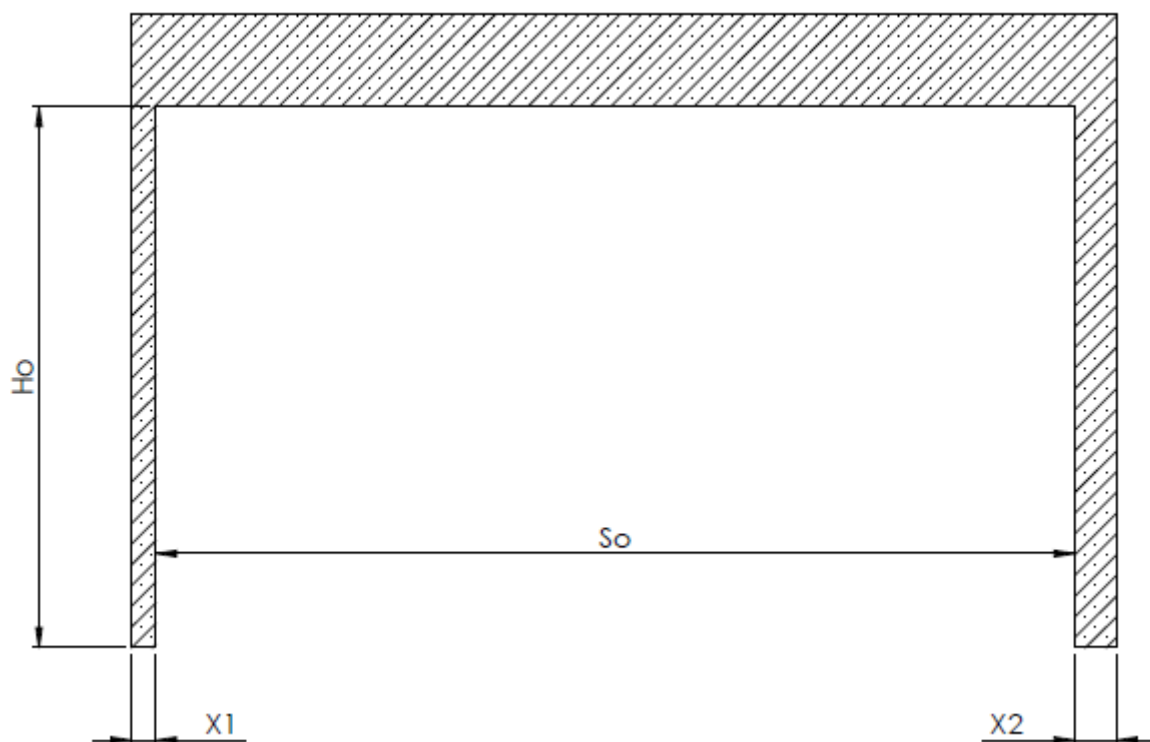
Vue de la surface du rideau coupe-feu EI préparée pour l'installation
